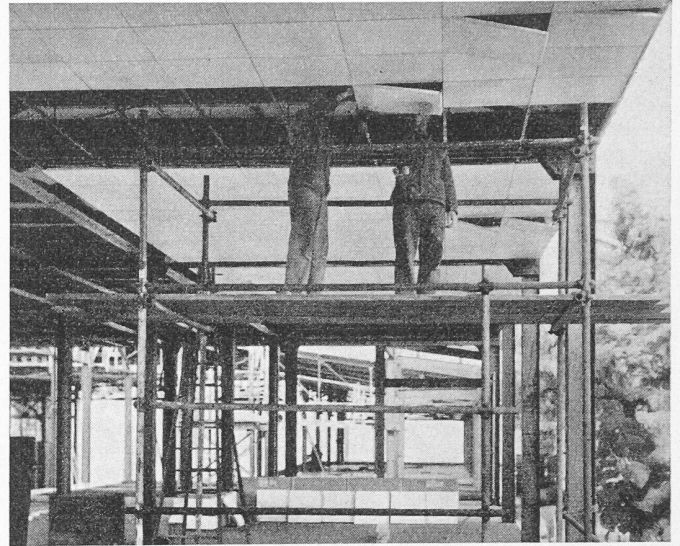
Montage der Deckenelemente im ALCOA-Building in Pittsburg, USA, wo insgesamt 22 500 m² Frenger-Decken montiert sind
